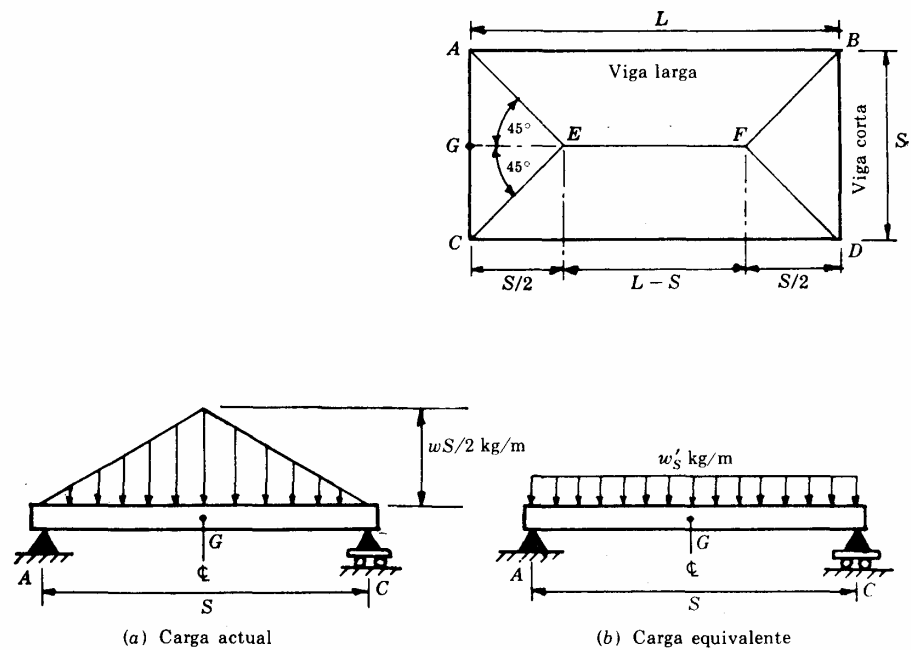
Distribución de cargas en las vigas a) carga triangular
